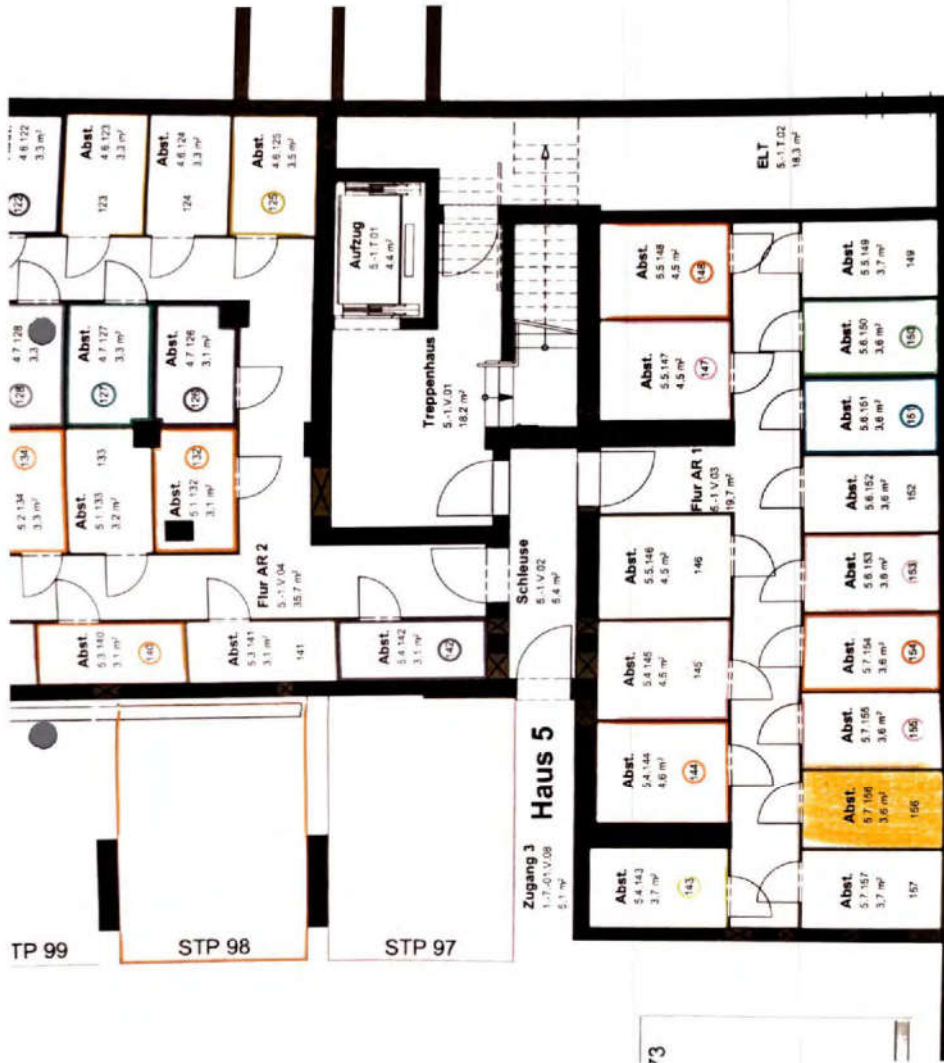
Teilgrundriss KG mit Kennzeichnung zugehöriger Kellerraum
